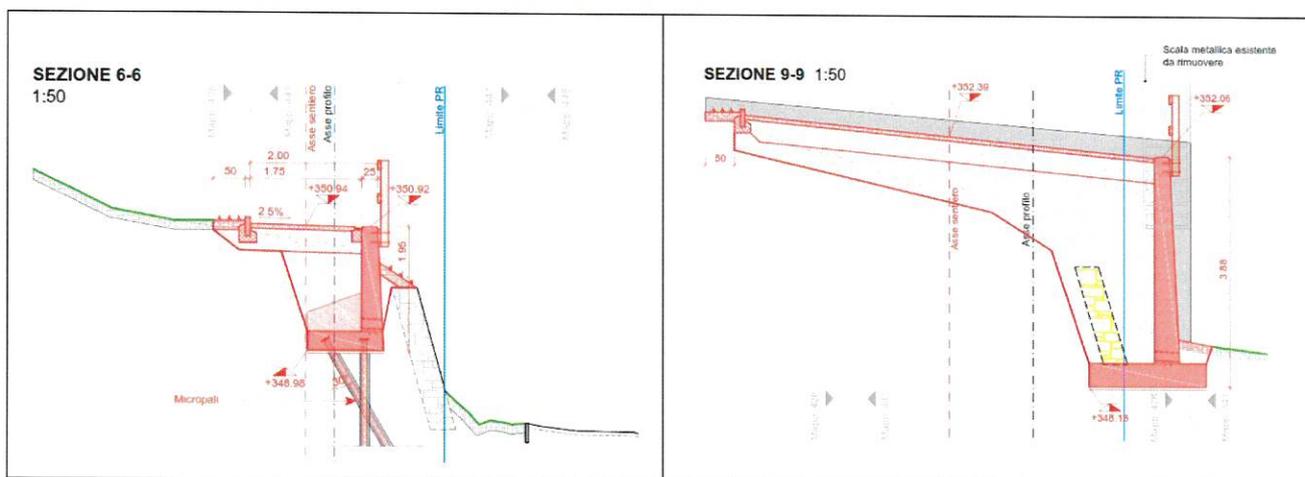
Sezioni trasversali, vedi piano 28-18.06 del progetto definitivo [3].
